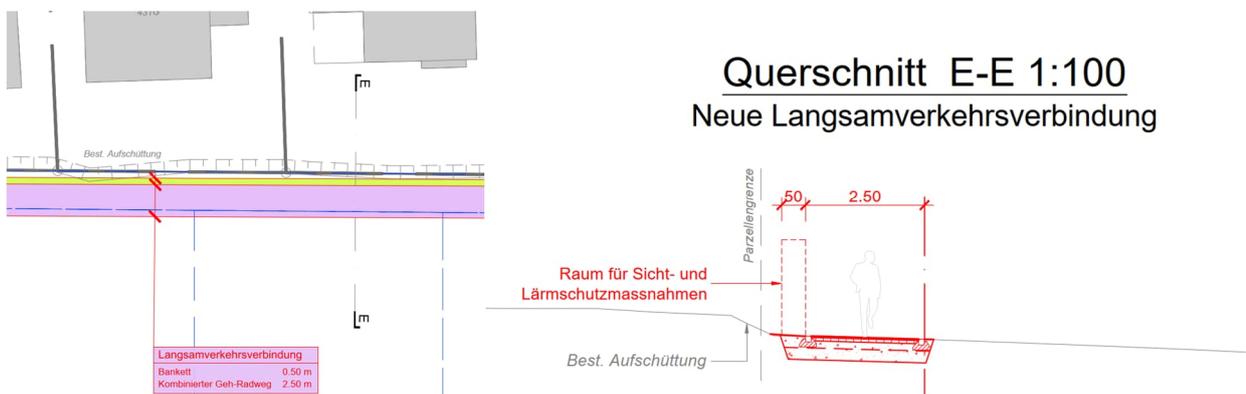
Langsamverkehrsverbindung lediglich mit Sicht- und Lärmschutzmassnahmen
